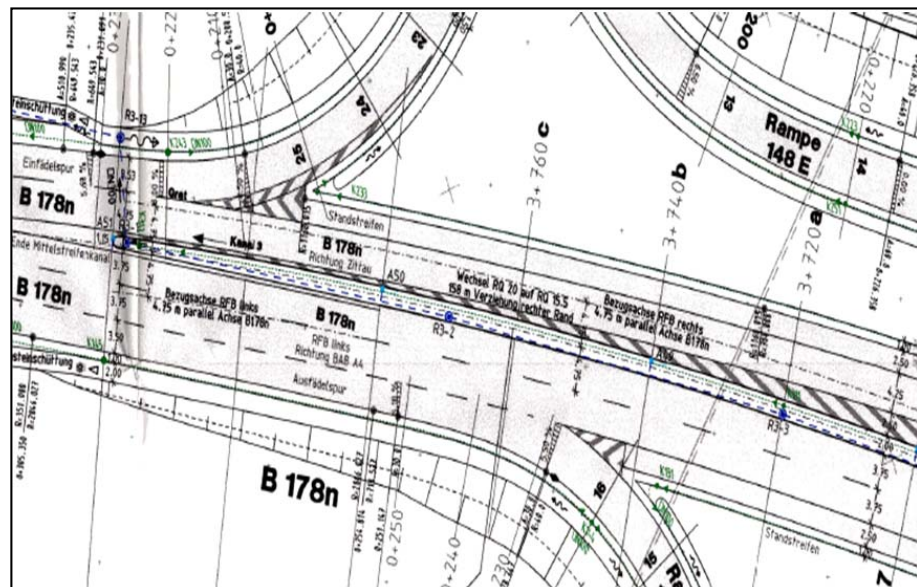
Lageplandarstellung des Übergangsbereichs Löbau-Süd (LASuV Bautzen)
